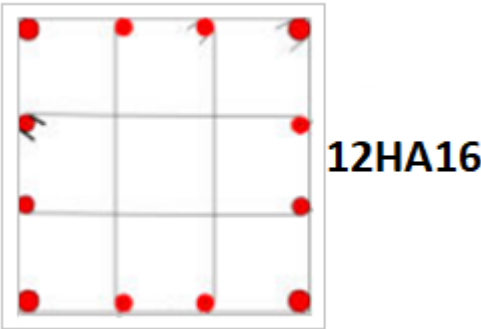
Schéma de ferraillage des poteaux de section 50 X 50 cm
